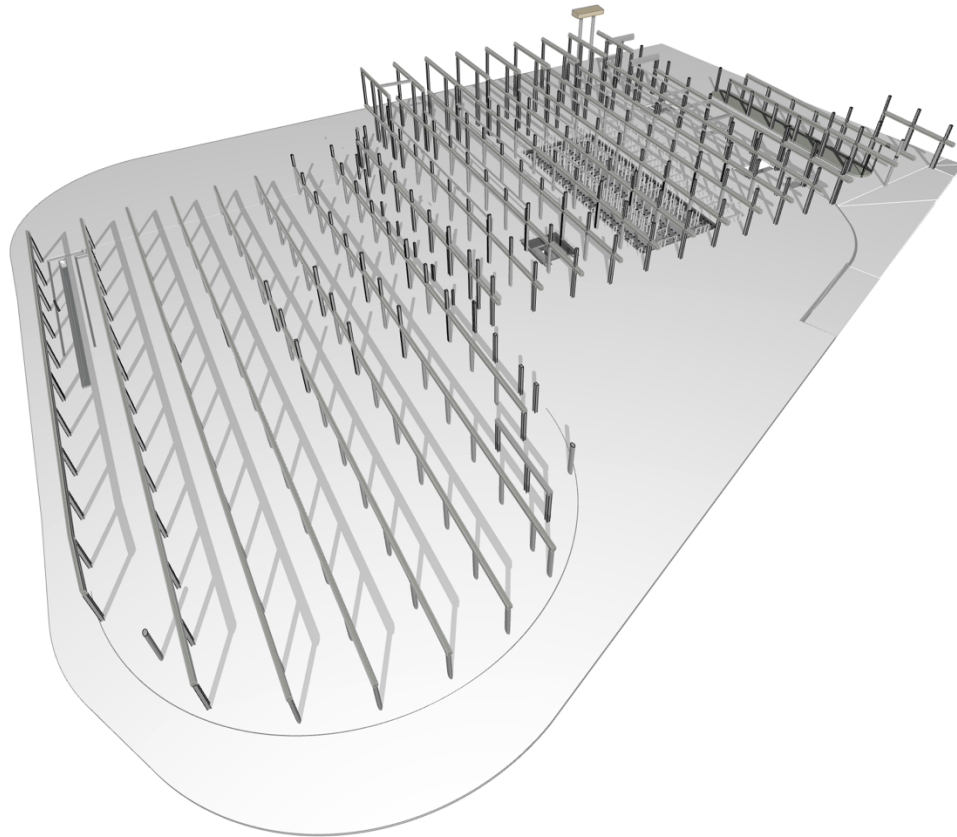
Volumetría final del conjunto de Vigas. Fuente: Elaboración propia.
